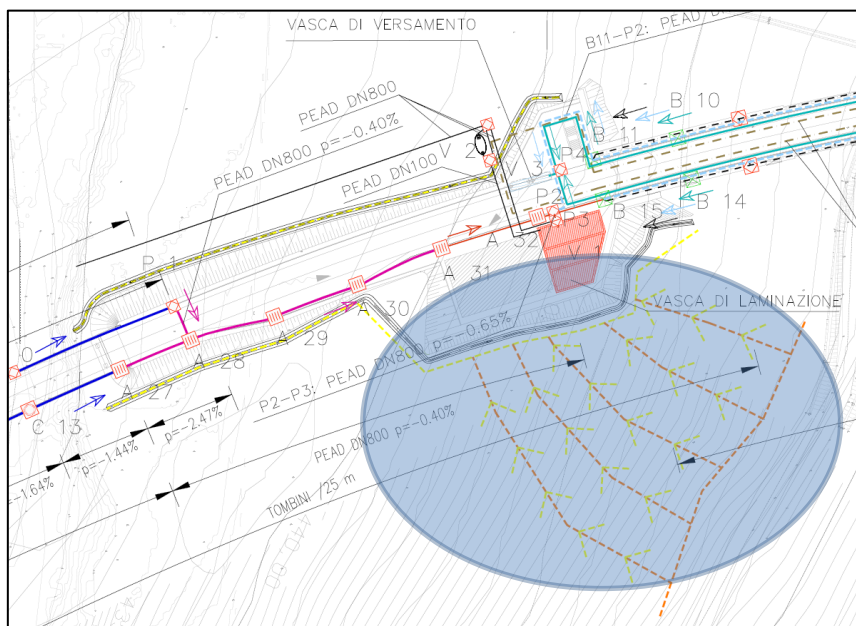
Indicazione e posizionamento delle trincee drenanti di versante per la mitigazione idraulica e intercettazione di falda.
